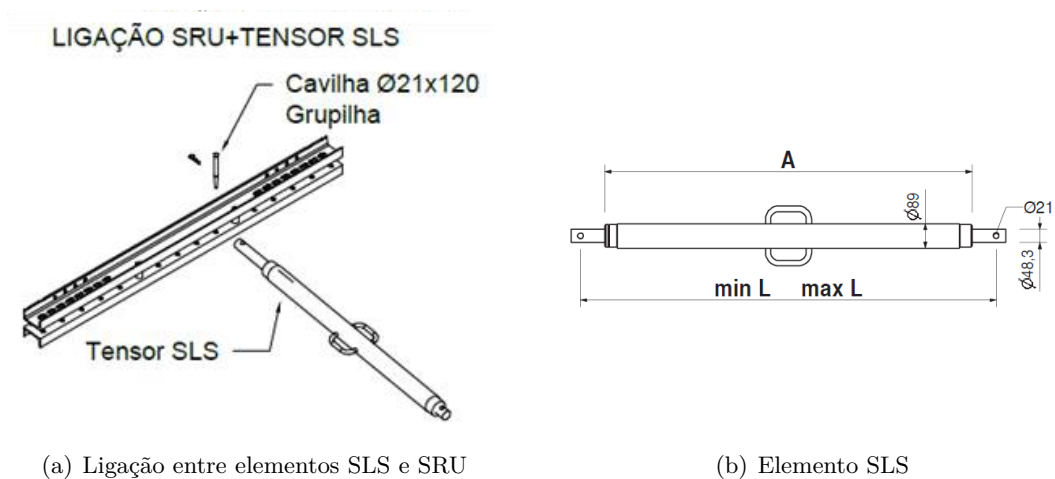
Elemento da estrutura de contenção de fachada: SLS. Retirado de [33]
